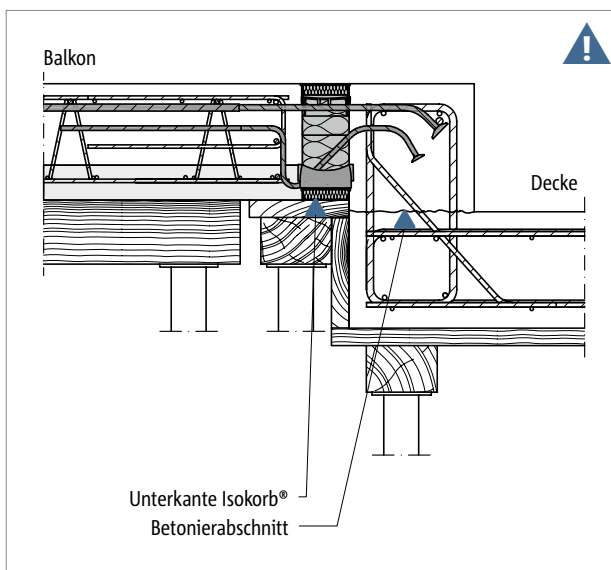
Schöck Isokorb® T Typ K-O-F: Halbfertigteilbalkon mit Höhenversatz nach oben
